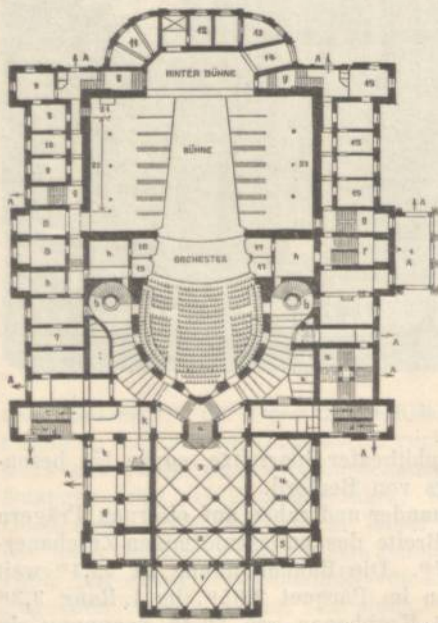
Grundriss in Parquethöhe. Hof-Theater in Schwerin (Architekt Daniel).
